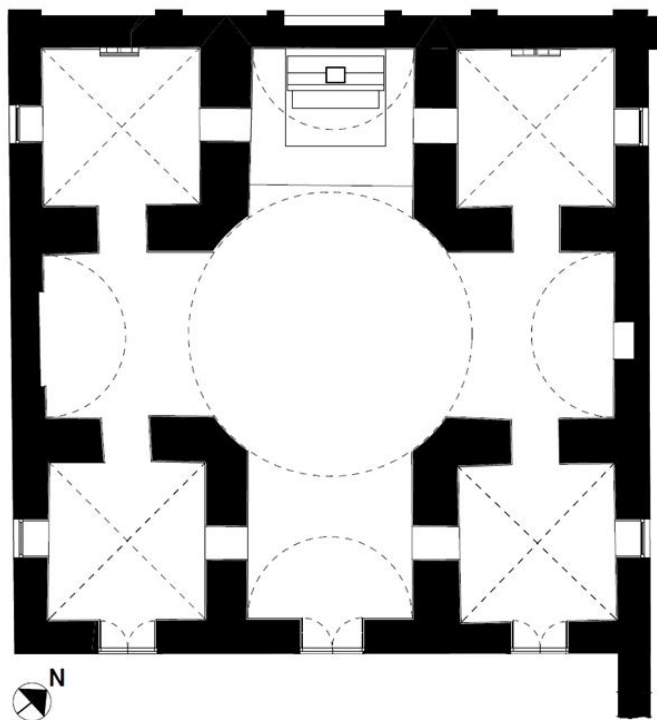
Planimetria della chiesa e sue caratterizzazioni.
